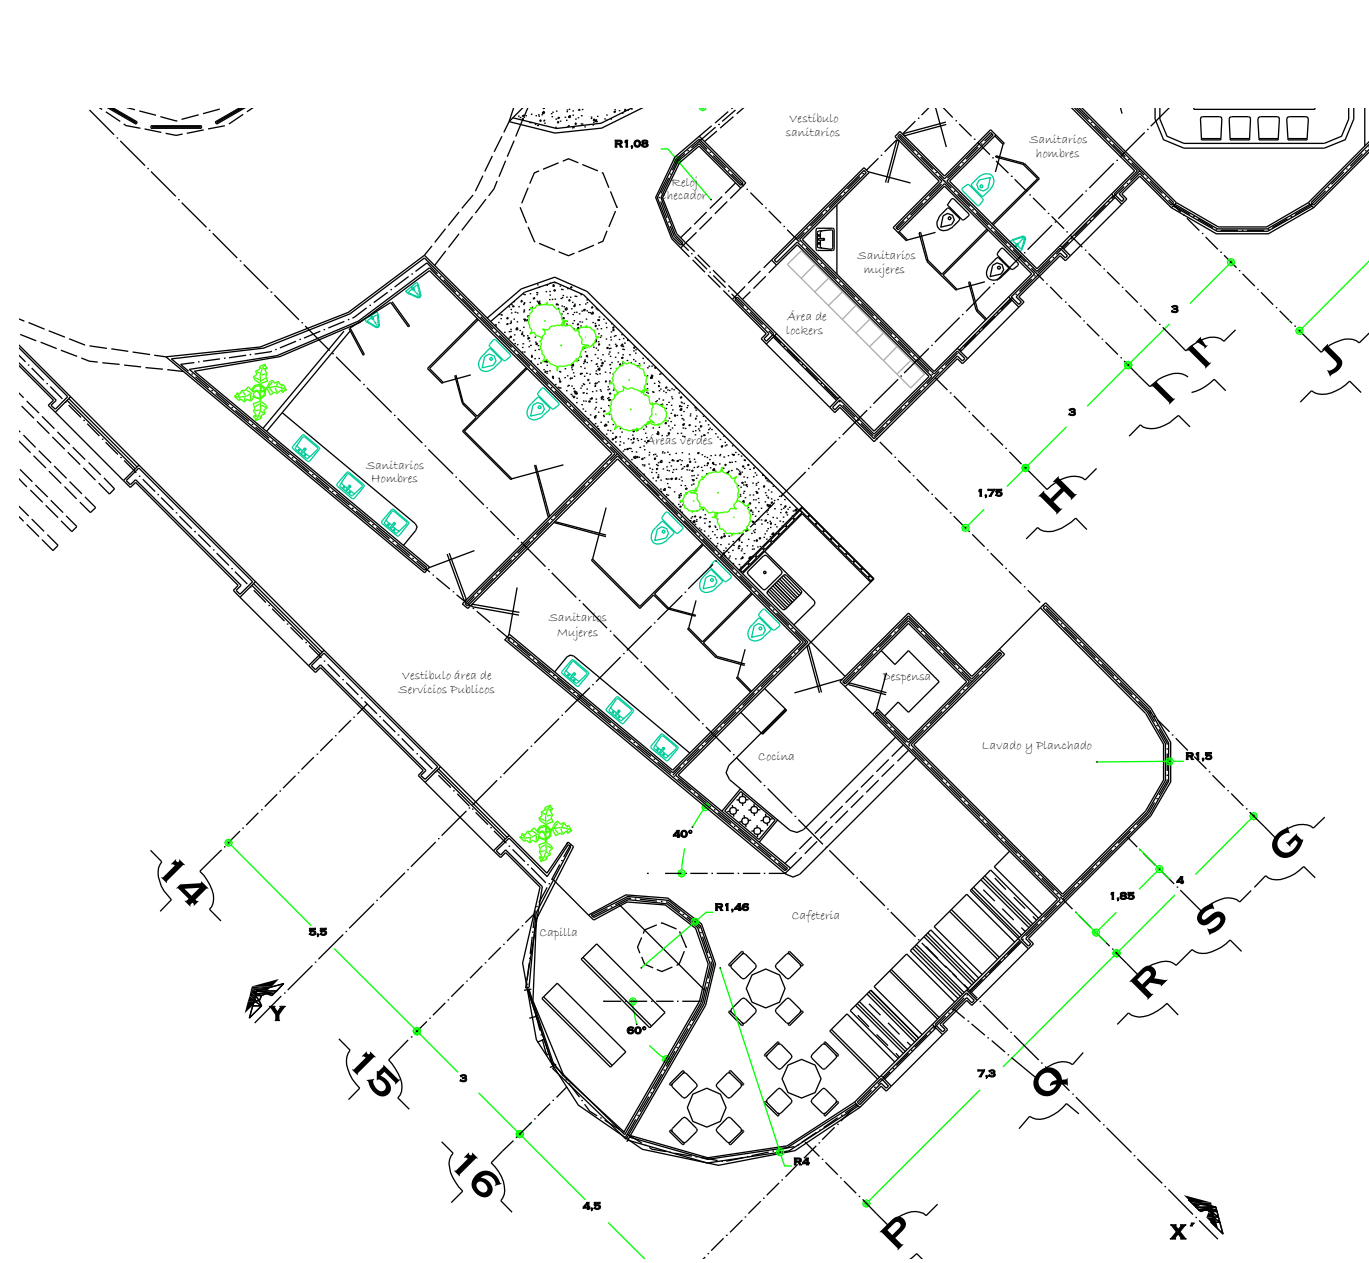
Planta Arquitectónica Zona de Esparcimiento.
